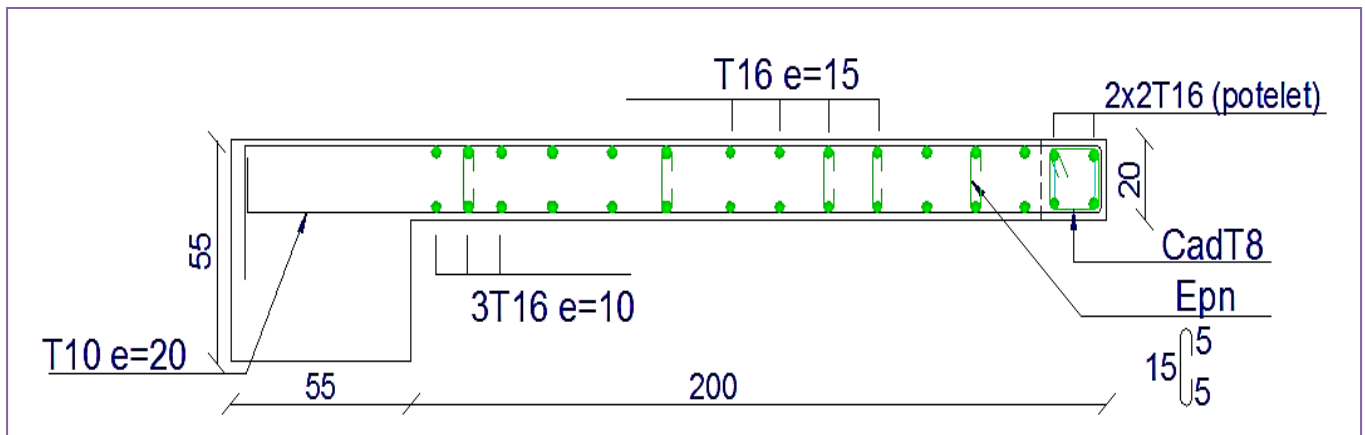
Schéma de ferrailage des voiles type V3 zone 1.
